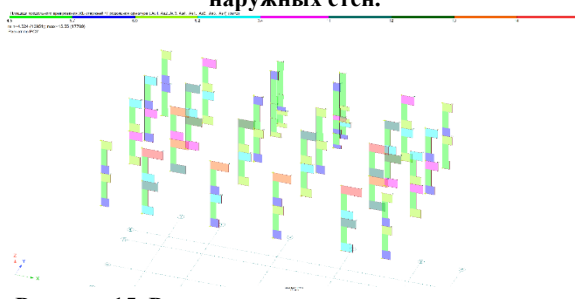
Расположение колонн и максимальная площадь армирование в колоннах на четвёртом и пятом этажах пяти этажного каркасного железобетонного здания с внутренними и наружными каркасно-обшивными стенами.
